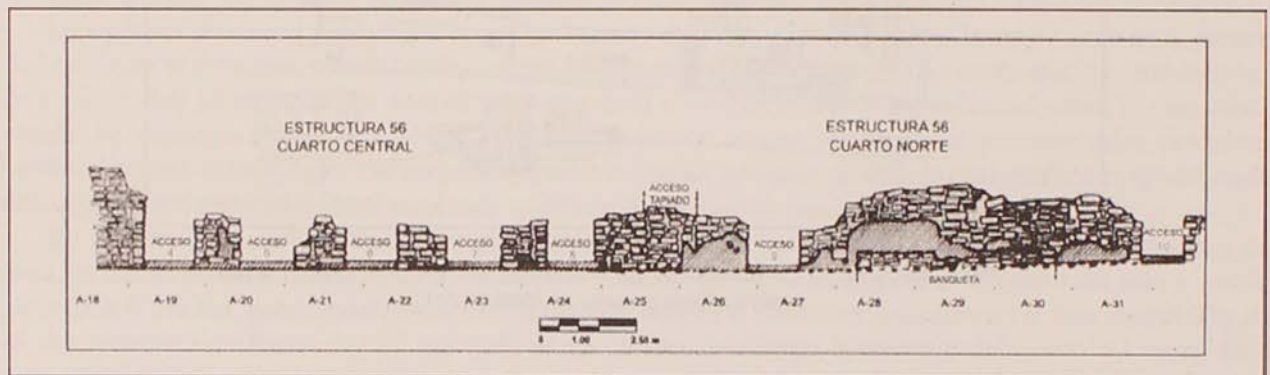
La Estructura 56, alzado de la zona central y norte con sus accesos.
